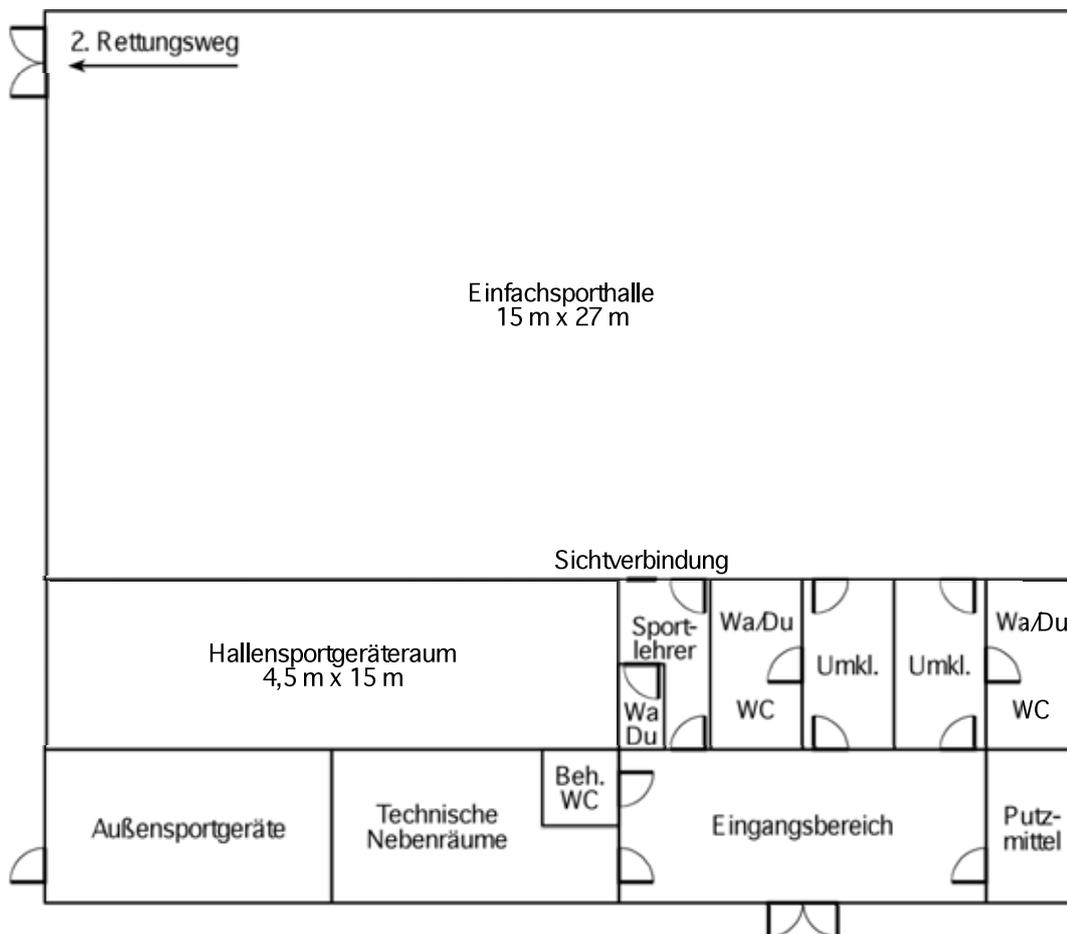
Möglicher Grundriss für eine Einfachhalle bei Einhaltung des Mindestraumprogramms
